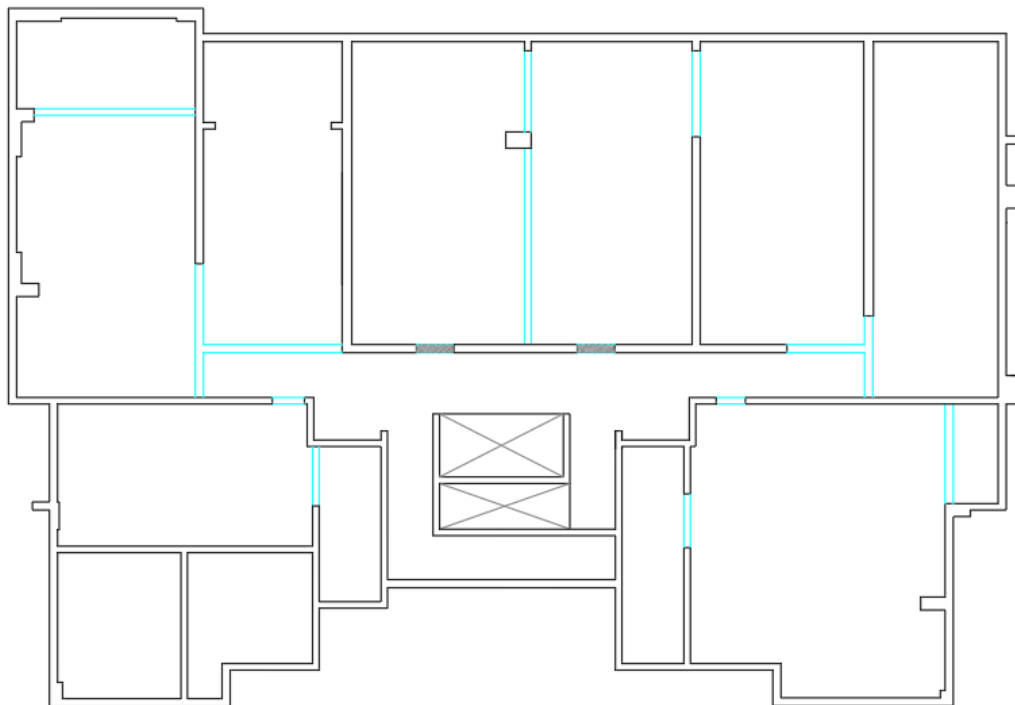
Adaptación de plano estructural de planta del subterráneo -2.
